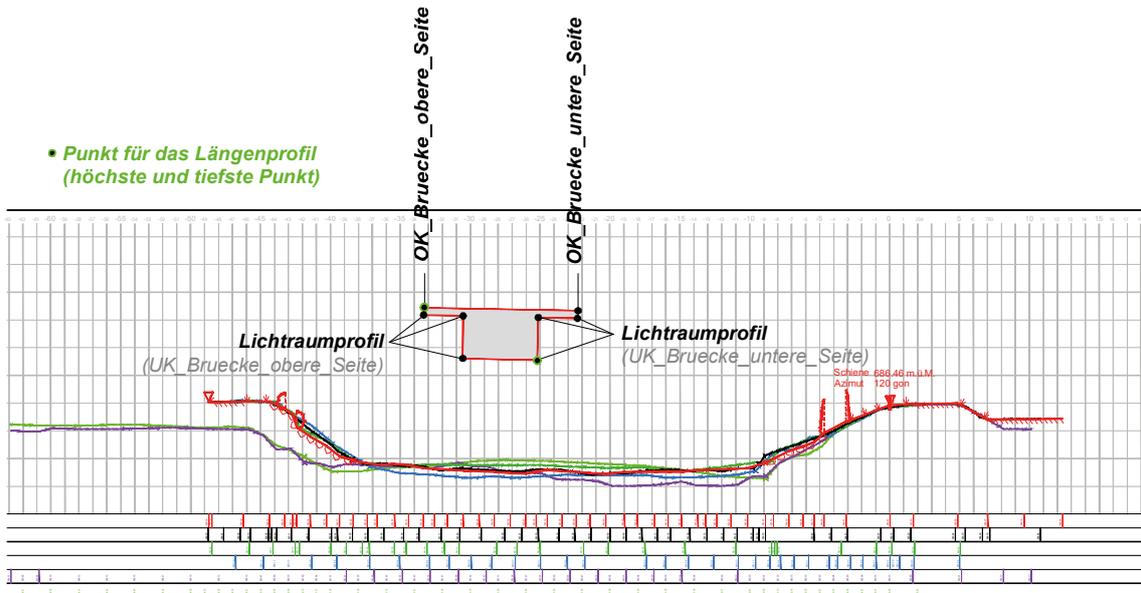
Beispiel Brückenschnitt, Querprofil GEWISS_Adr. 218566
